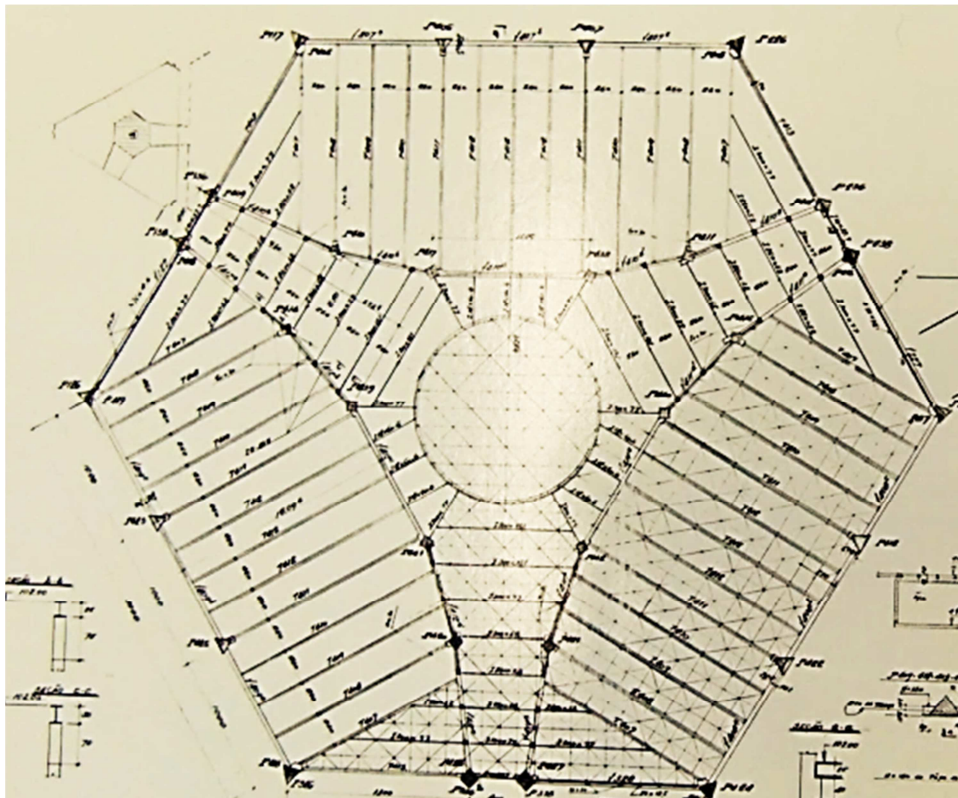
Sergio Bernardes, ESG, DF, 1970/74. Planta estrutural – fôrmas laje piso 1º pavimento. Fonte: Acervo Sergio Bernardes - NPD/UFRJ.
